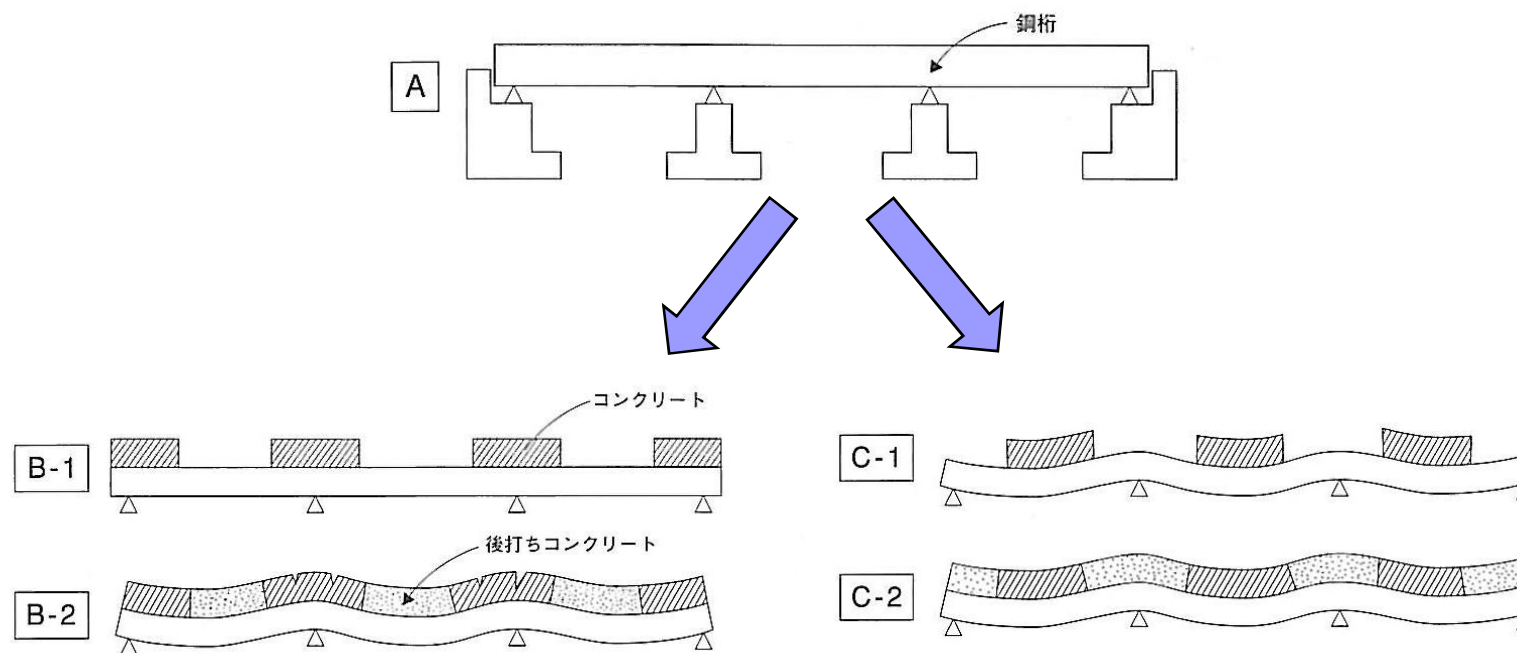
合成桁におけるコンクリートの打設順序とひび割れの概念
